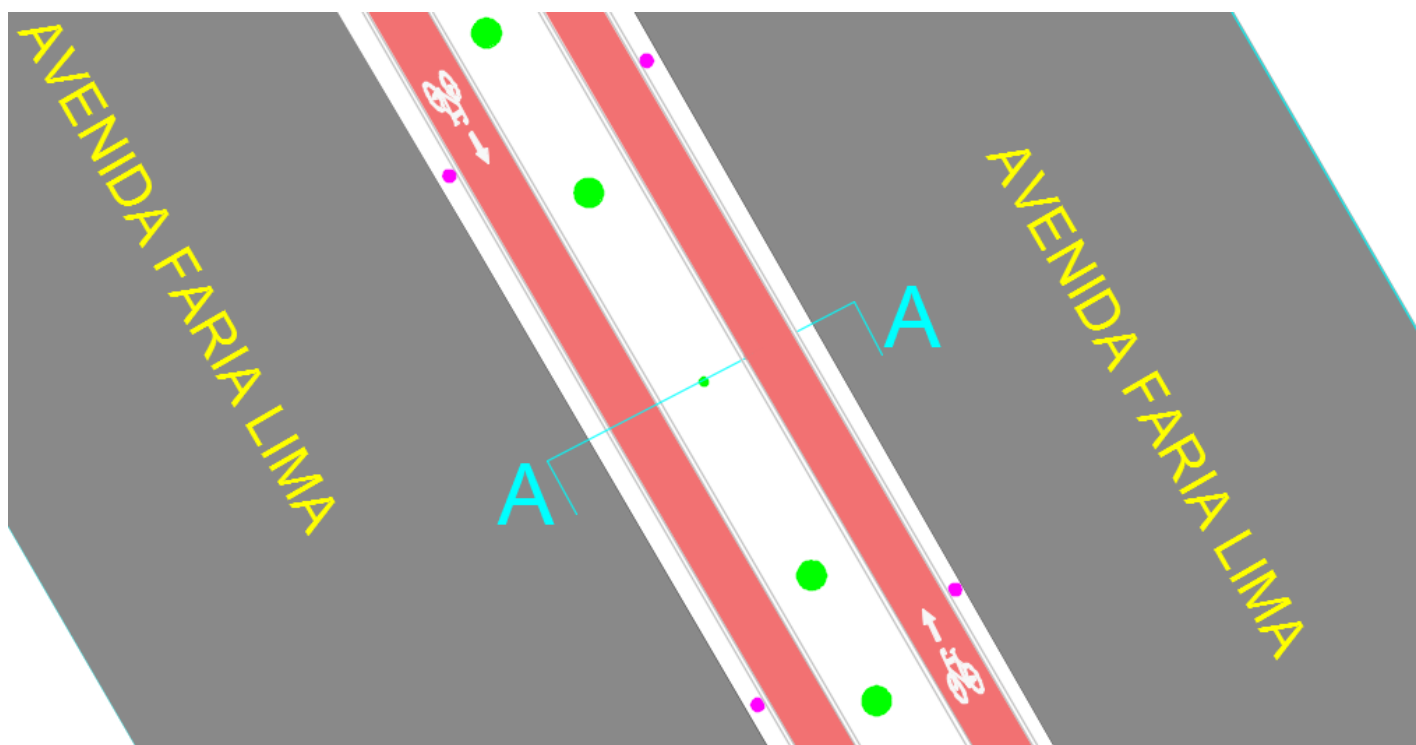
Planta com a alternativa de replantio sem desvio (Fonte: Autoria própria)
